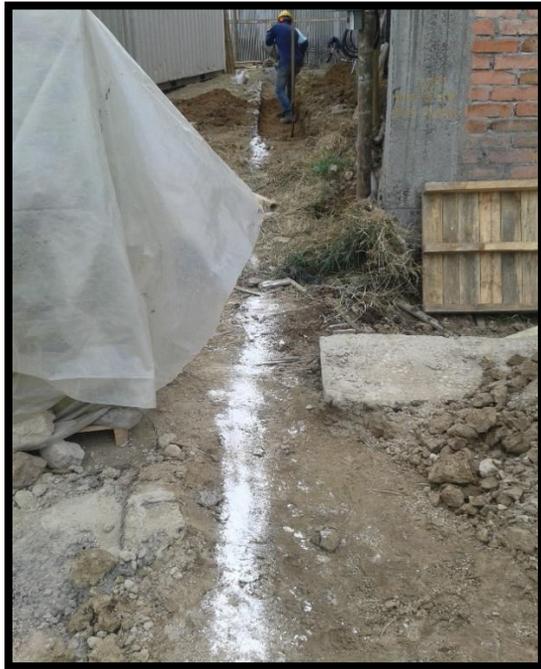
Replanteo pantallas y barretes pre-excavados. (Fuente: Propia)
